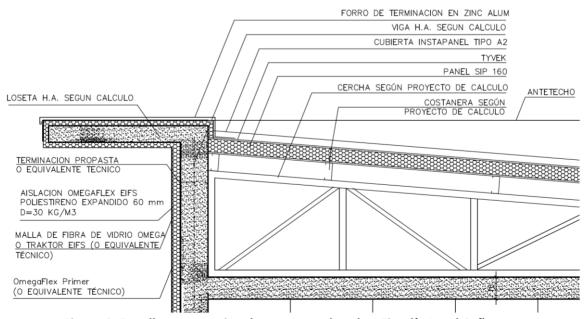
Detalle constructivo de muro y techumbre Fiscalía Local Cañete.
